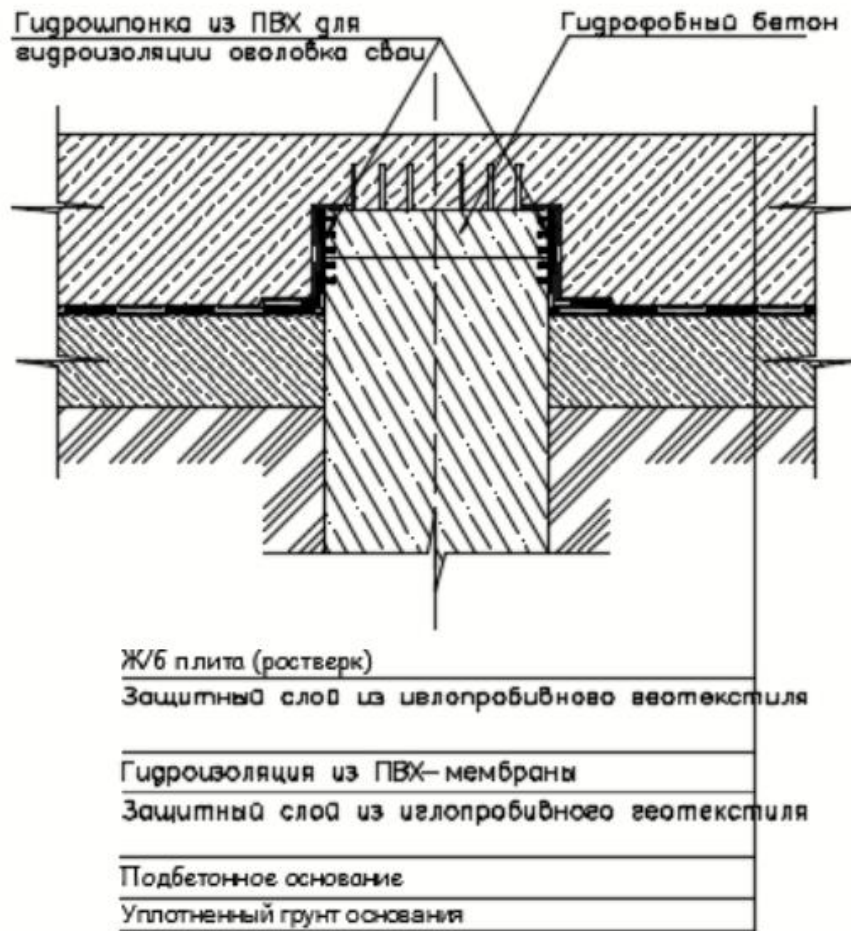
Устройство гидроизоляции оголовка сваи (чертеж автора)
